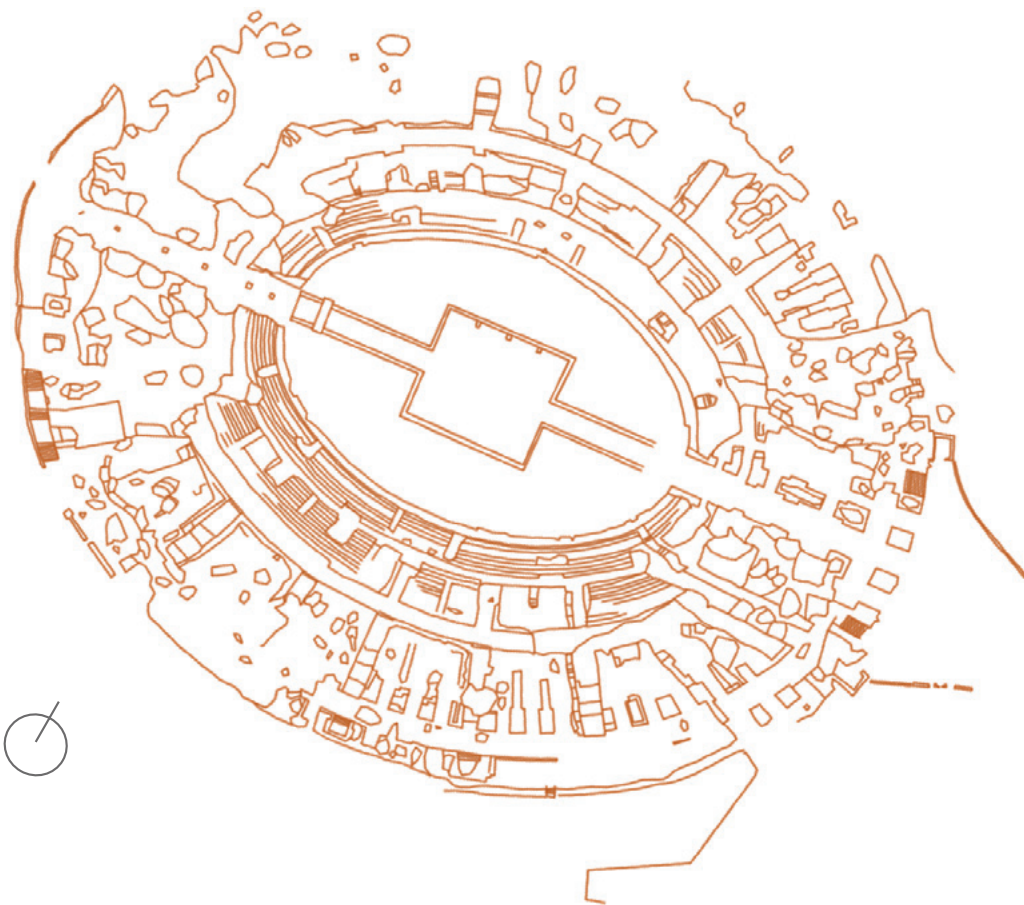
Plano del estado actual del anfiteatro (fuente: R. Angulo, 2009. *Elaboración de las fichas diagnóstico de los bienes inmuebles del CAI*)
